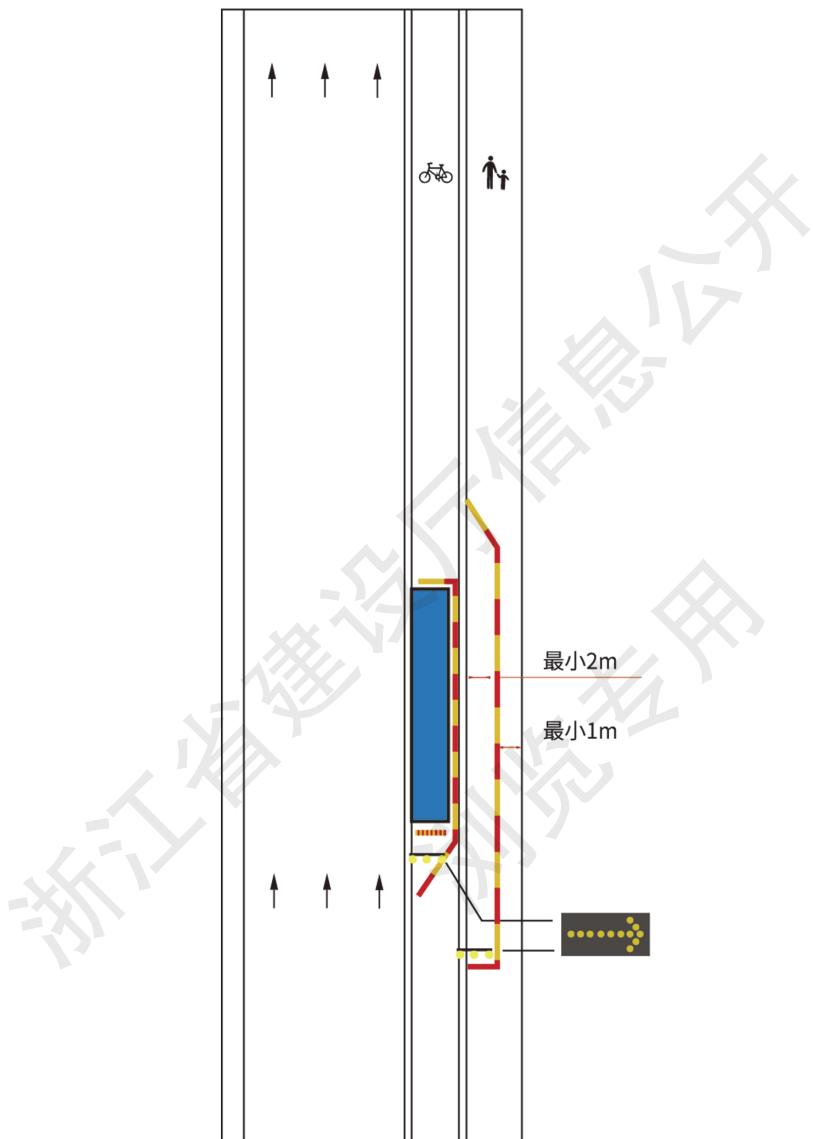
主干道非机动车道养护作业控制区布置示意
